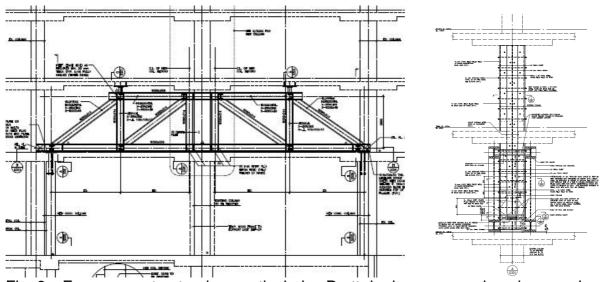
Esquema estructural con reticulados Pratt de dos vanos, adosados a cada lado de la columna (vista frontal).
